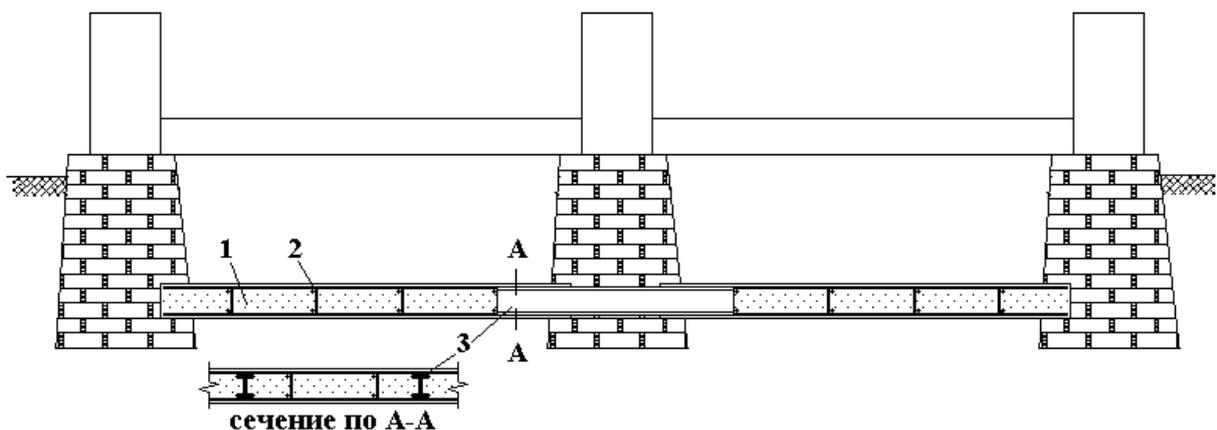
Подведение фундаментной плиты: 1 – бетон; 2 – арматура; 3 – балка
